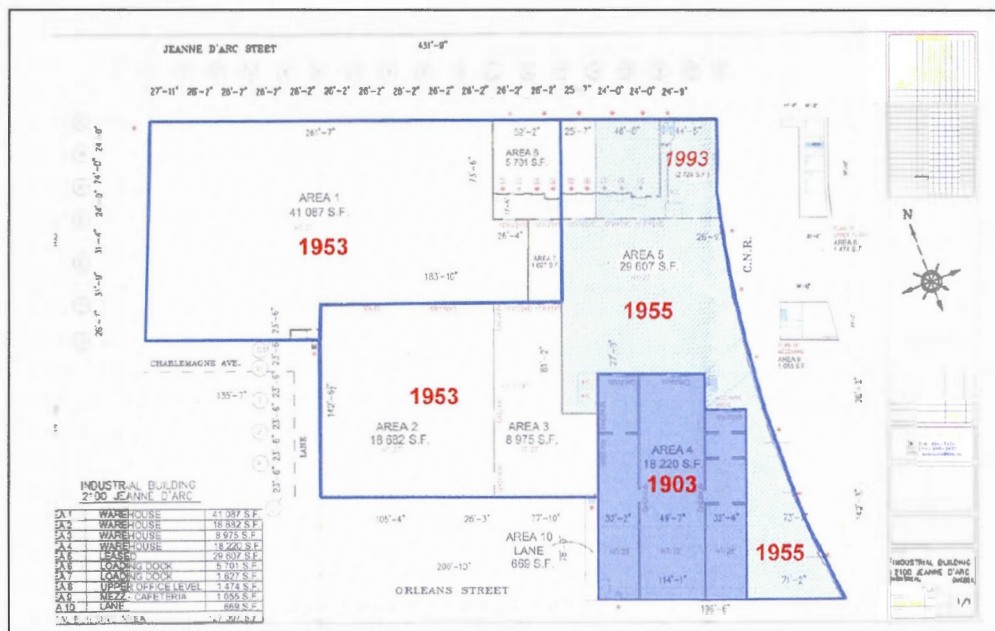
Date de construction des sections du bâtiment situé au 2100, avenue Jeanne-d'Arc
